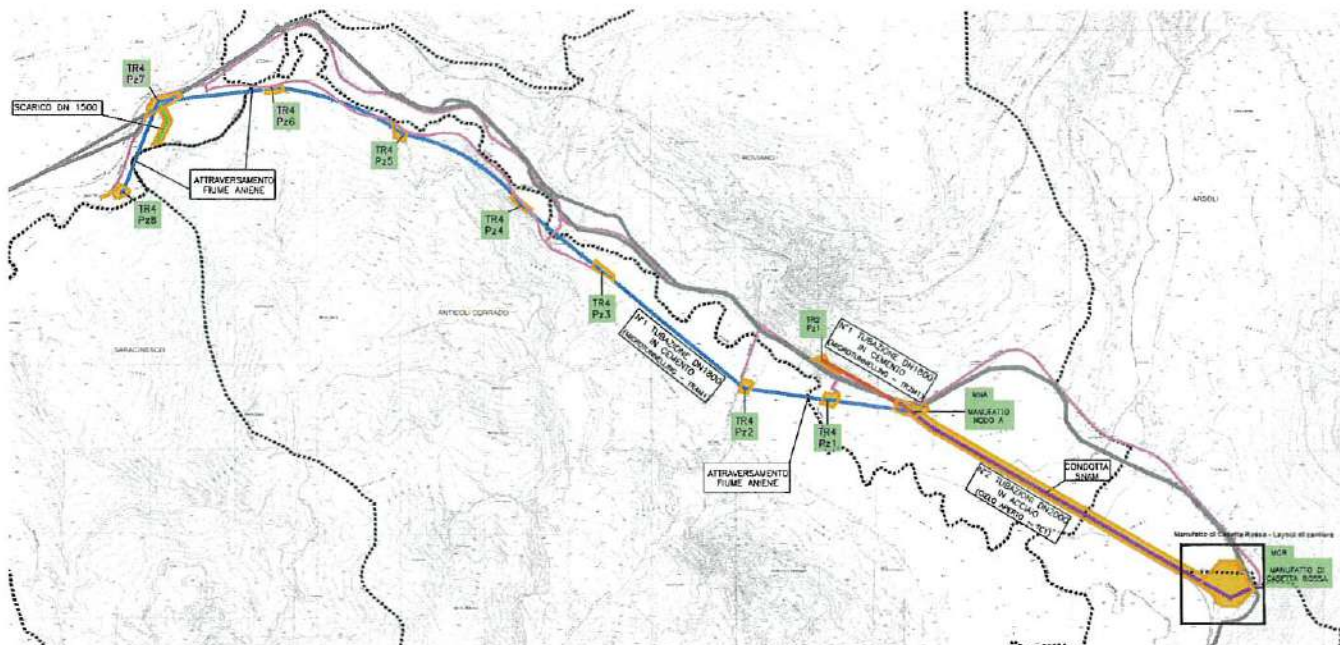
Aree di cantiere della prima fase funzionale (cfr. estratto elaborato A250-SIA-D-036-0 Planimetria delle aree di cantiere)
